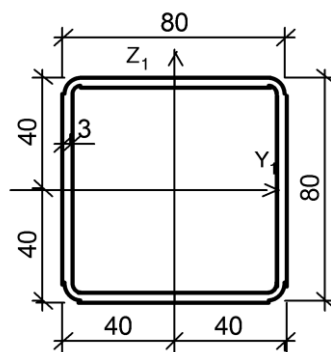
Поперечное сечение опорного раскоса фермы
